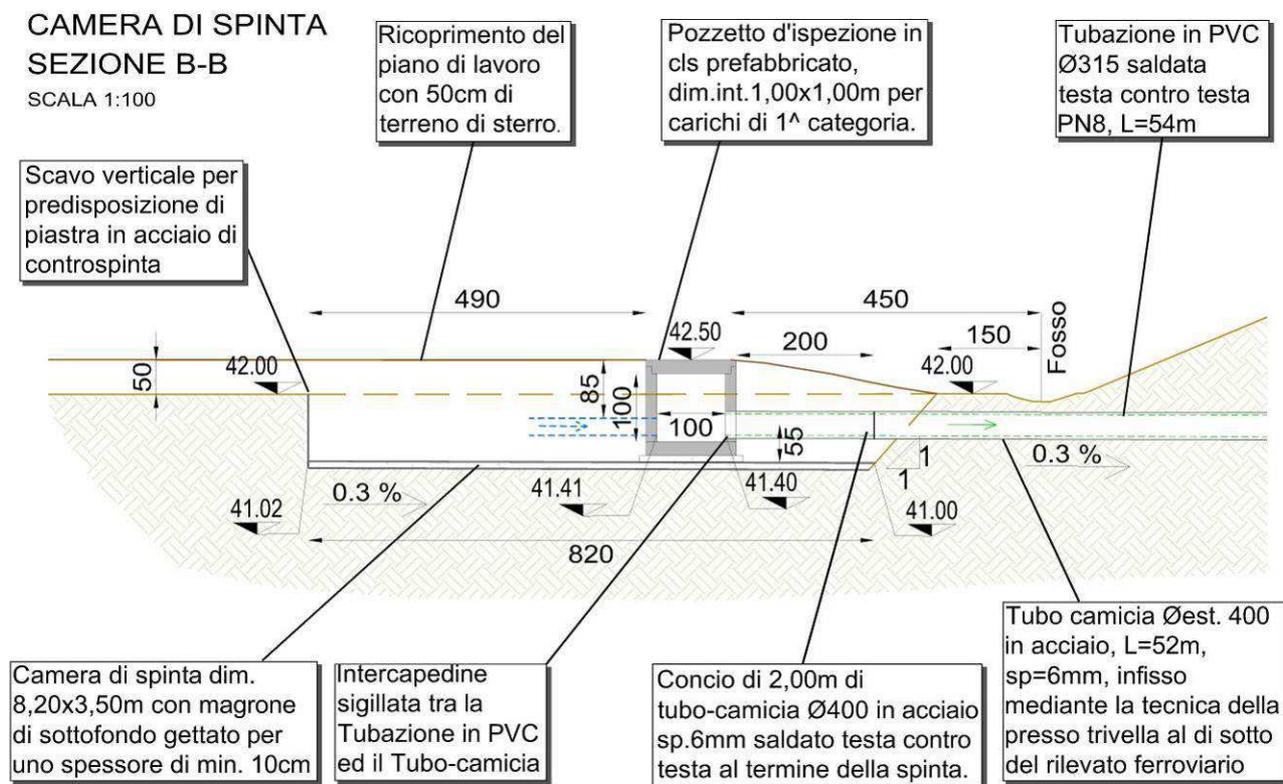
MANUFATTO DI VALLE DELL'ATTRAVERSAMENTO (STRALCIO ALLEGATO 1 – TAV.02)
